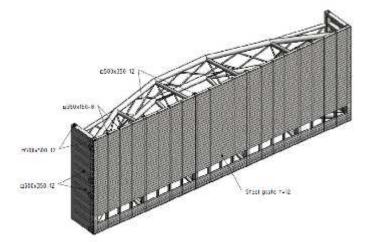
Detalles de la compuerta levadiza (parte delantera y parte posterior)
